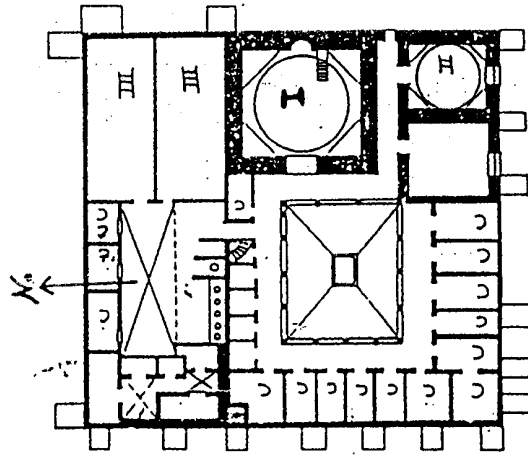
مسقط أفقي لجامع عثمان باشا (١) ضمن مجمعه بحلب (عن : Sauvaget)
